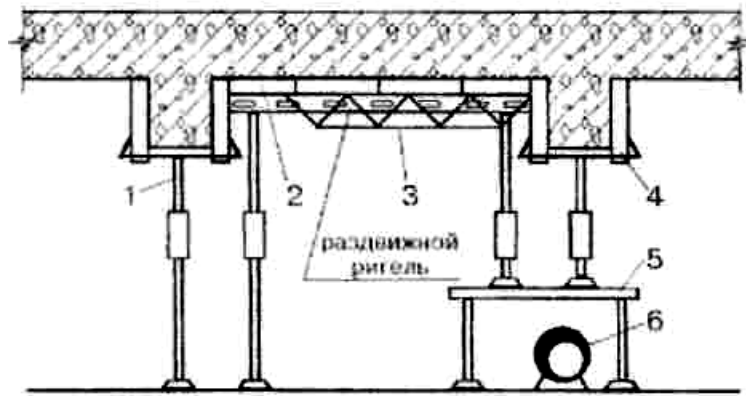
Схема установки опалубки при бетонуванні перекриття:
